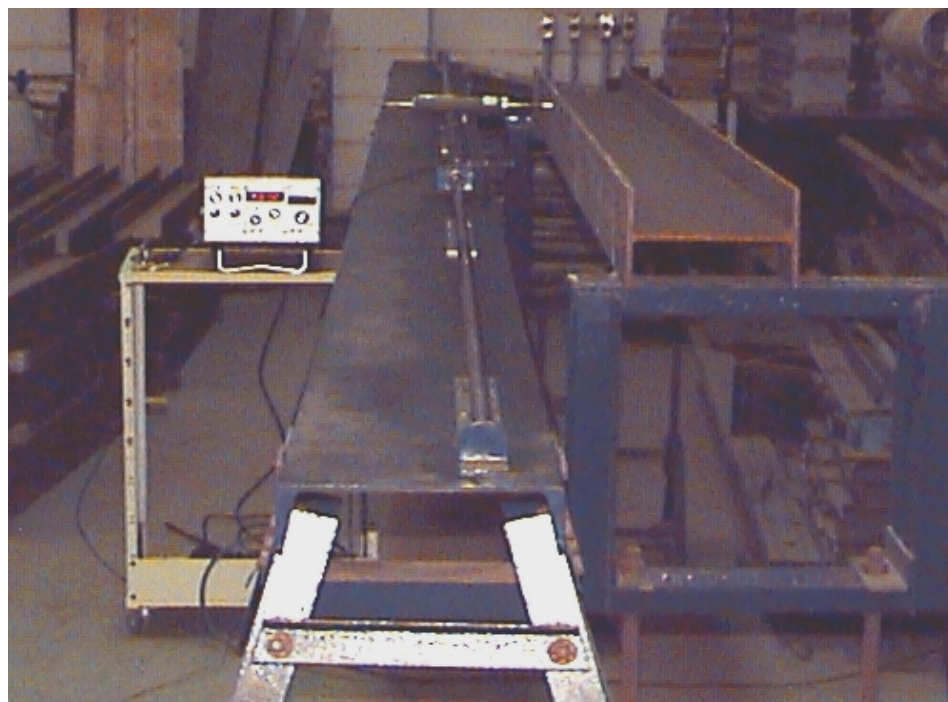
Dispositivo para leitura das imperfeições geométricas transversais.
